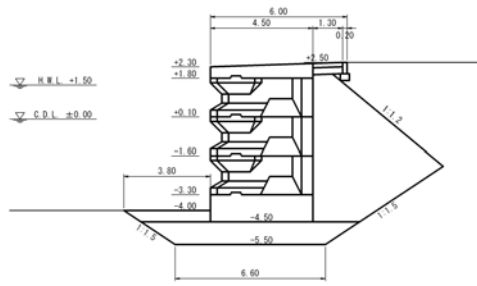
4.0m岸壁（直立消波ブロック式）断面図
